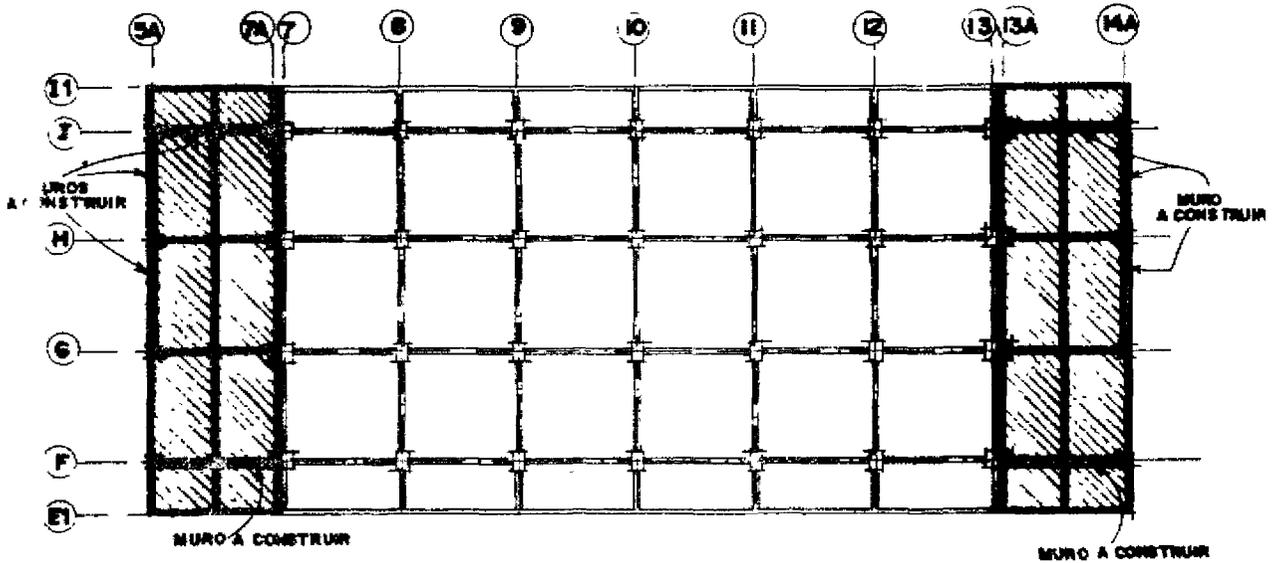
PLANTA ESTRUCTURAL EDIFICIO QUIROFANOS
